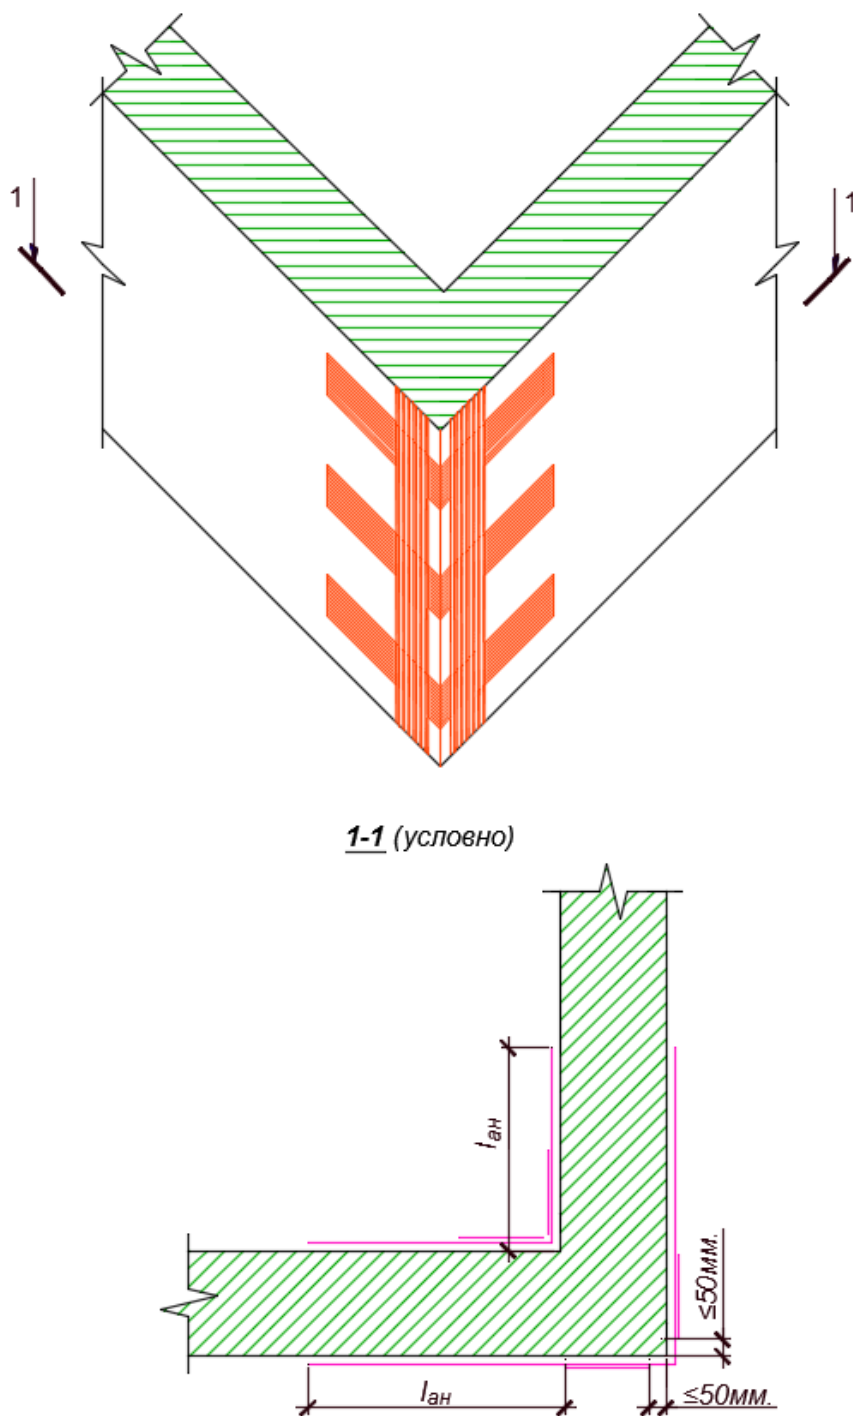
Усиление сопряжения стен (угловое)
